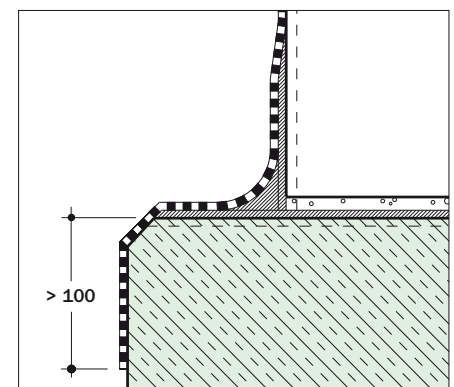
Anschluss einer einkomponentigen KMB-Abdichtung am Bodenplattenabsatz, Querschnittsabdichtung und Untergrundvorbehandlung mit rissüberbrückender MDS
